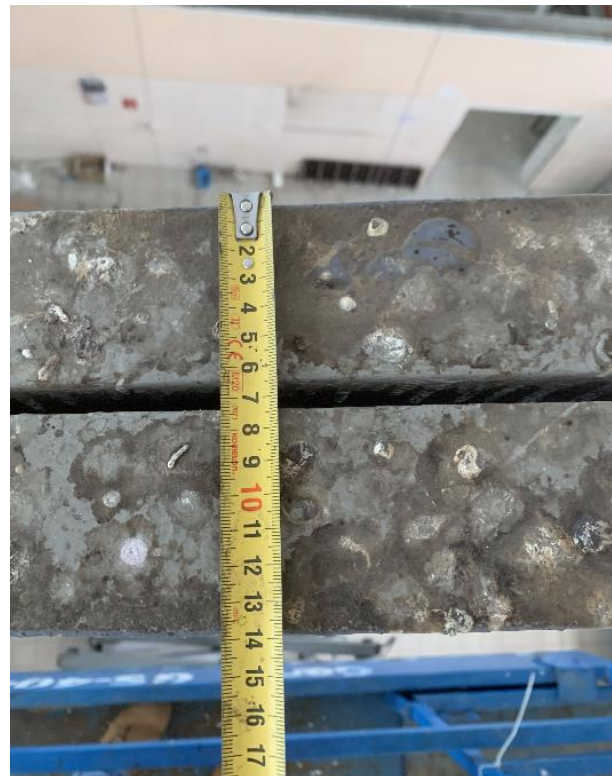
Kopnes apakšjoslas T profils (divi L profili)
